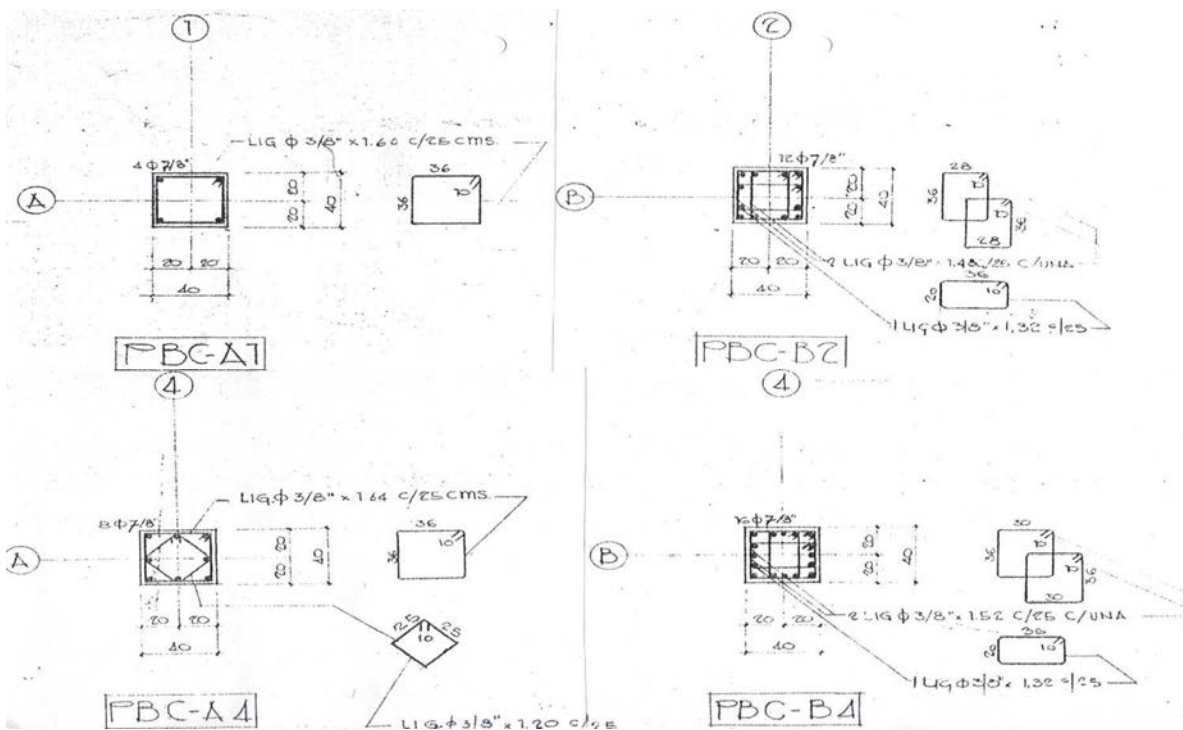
Detalles de columnas. Tipo Cajetón
